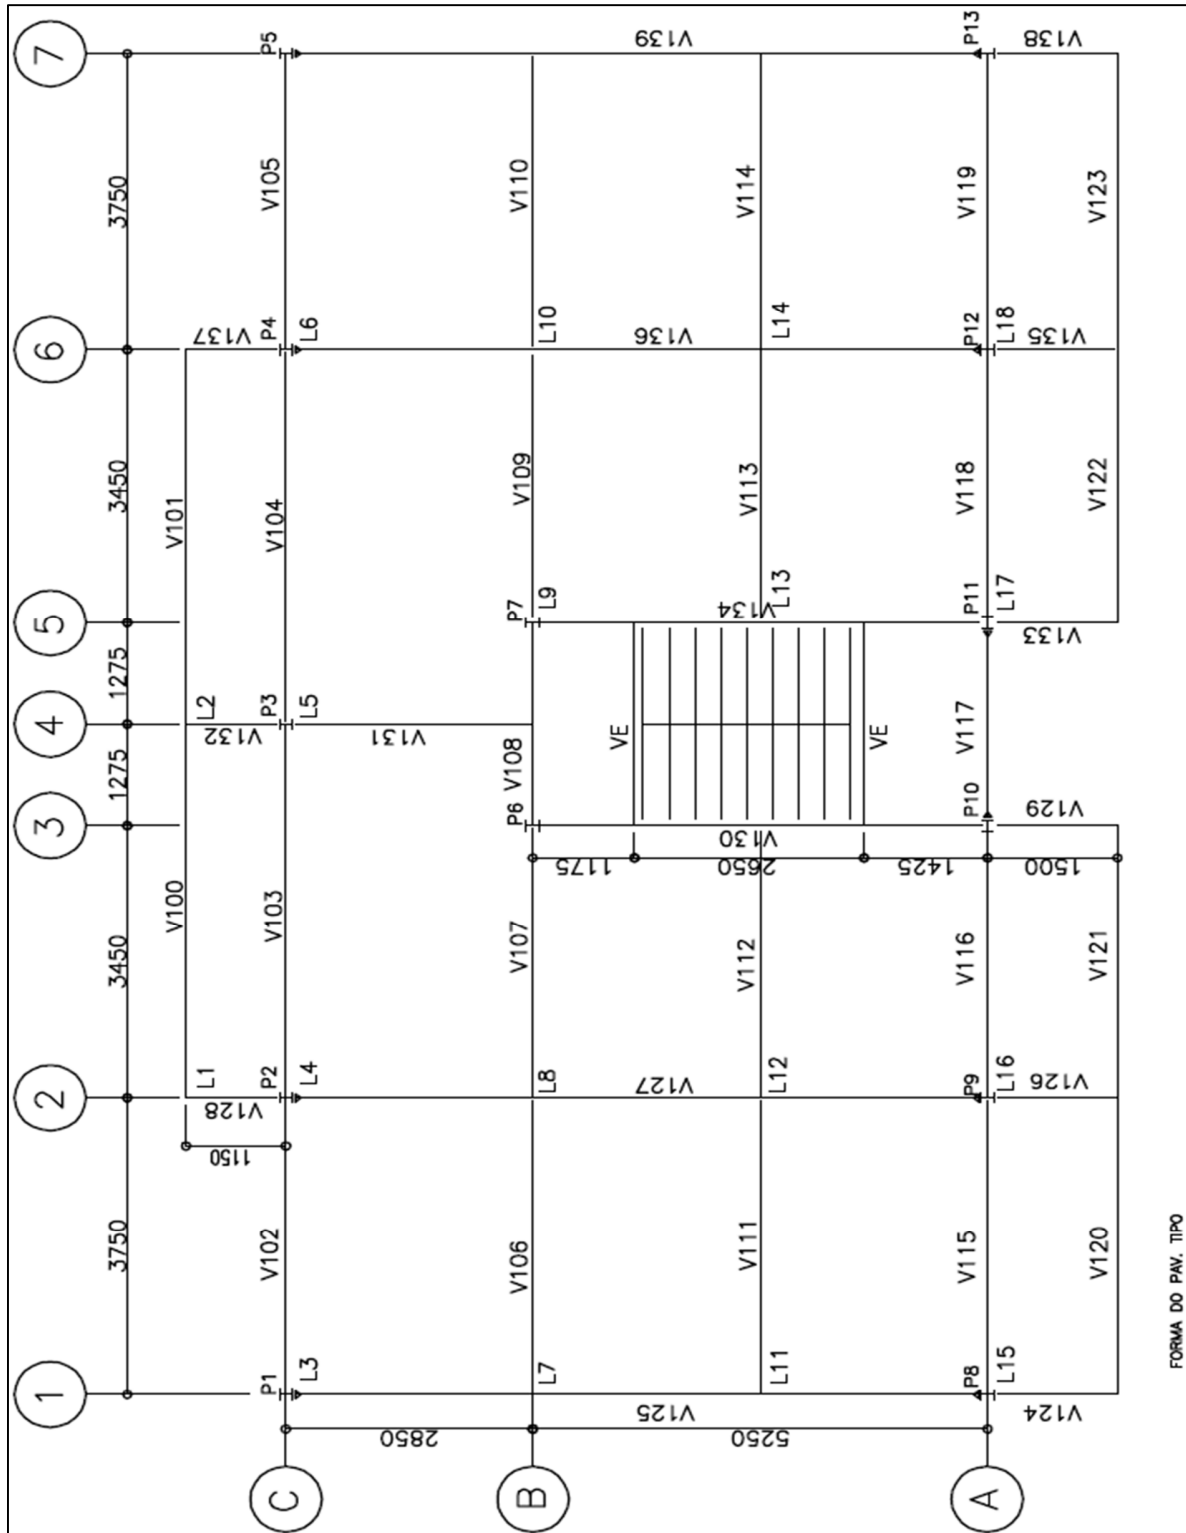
Plano das vigas (El. +3500 @ +10500)
